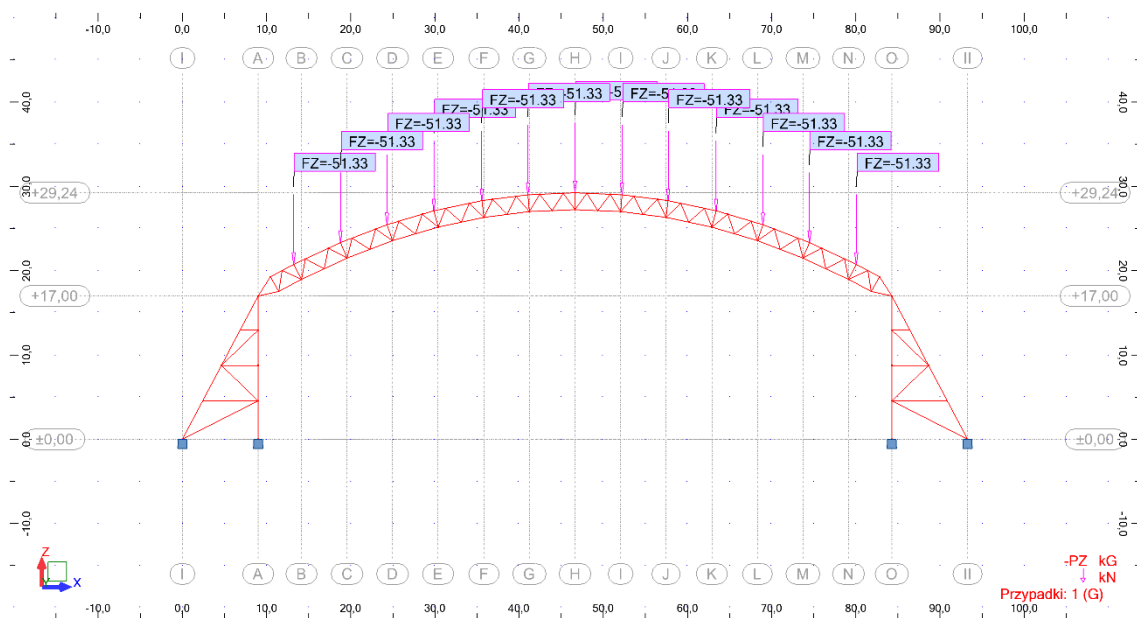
Przyjęte przypadające obciążenia na konstrukcje hali
